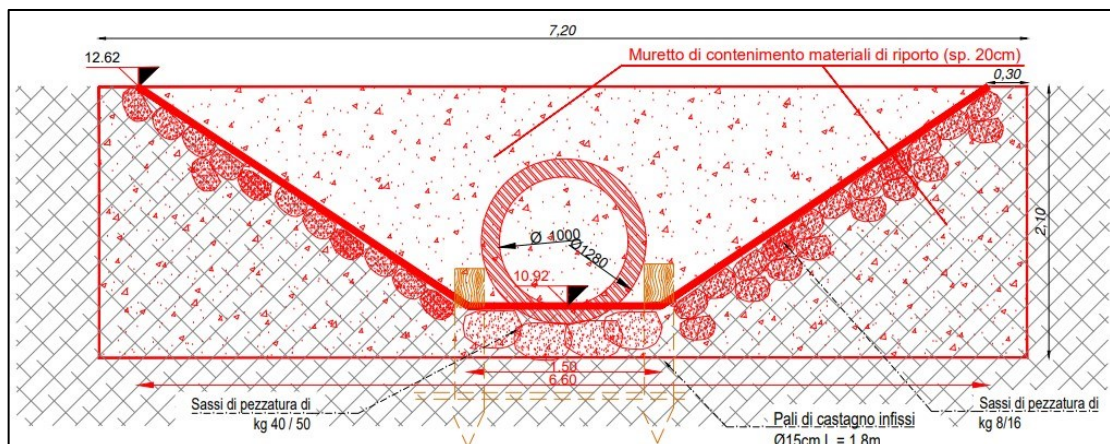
Prospetto dell'attraversamento carraio nel punto 8
